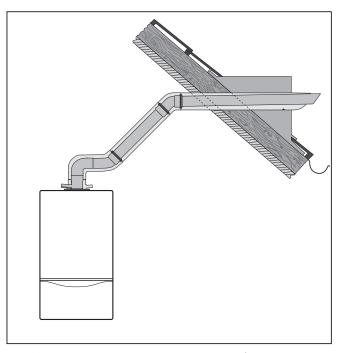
Пример монтажа горизонтального стенного/ кровельного ввода
